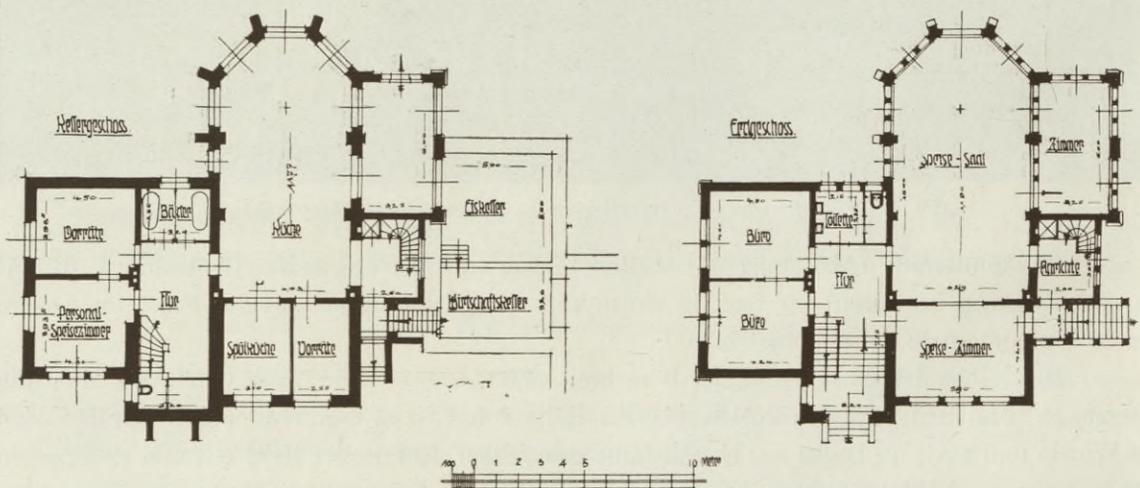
und 12. Viktoria-Luise-Kinderheilstätte. Grundrisse des Hauptgebäudes.
